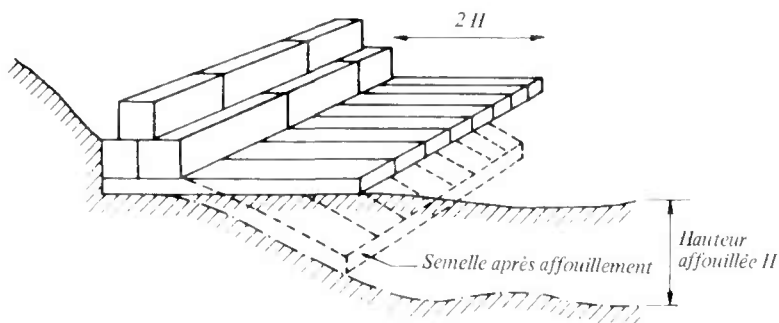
Déformation de la semelle d'un ouvrage en gabions après affouillement.
